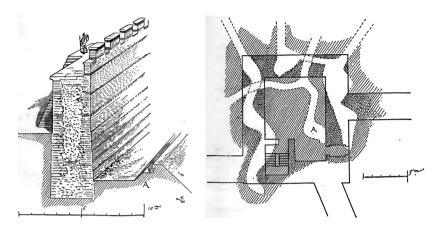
Construcción y defensa en los muros de la fortaleza cuya historia narra Viollet (1874, figs. 17 y 33). Sección de un muro y planta de las minas excavadas bajo un torreón
